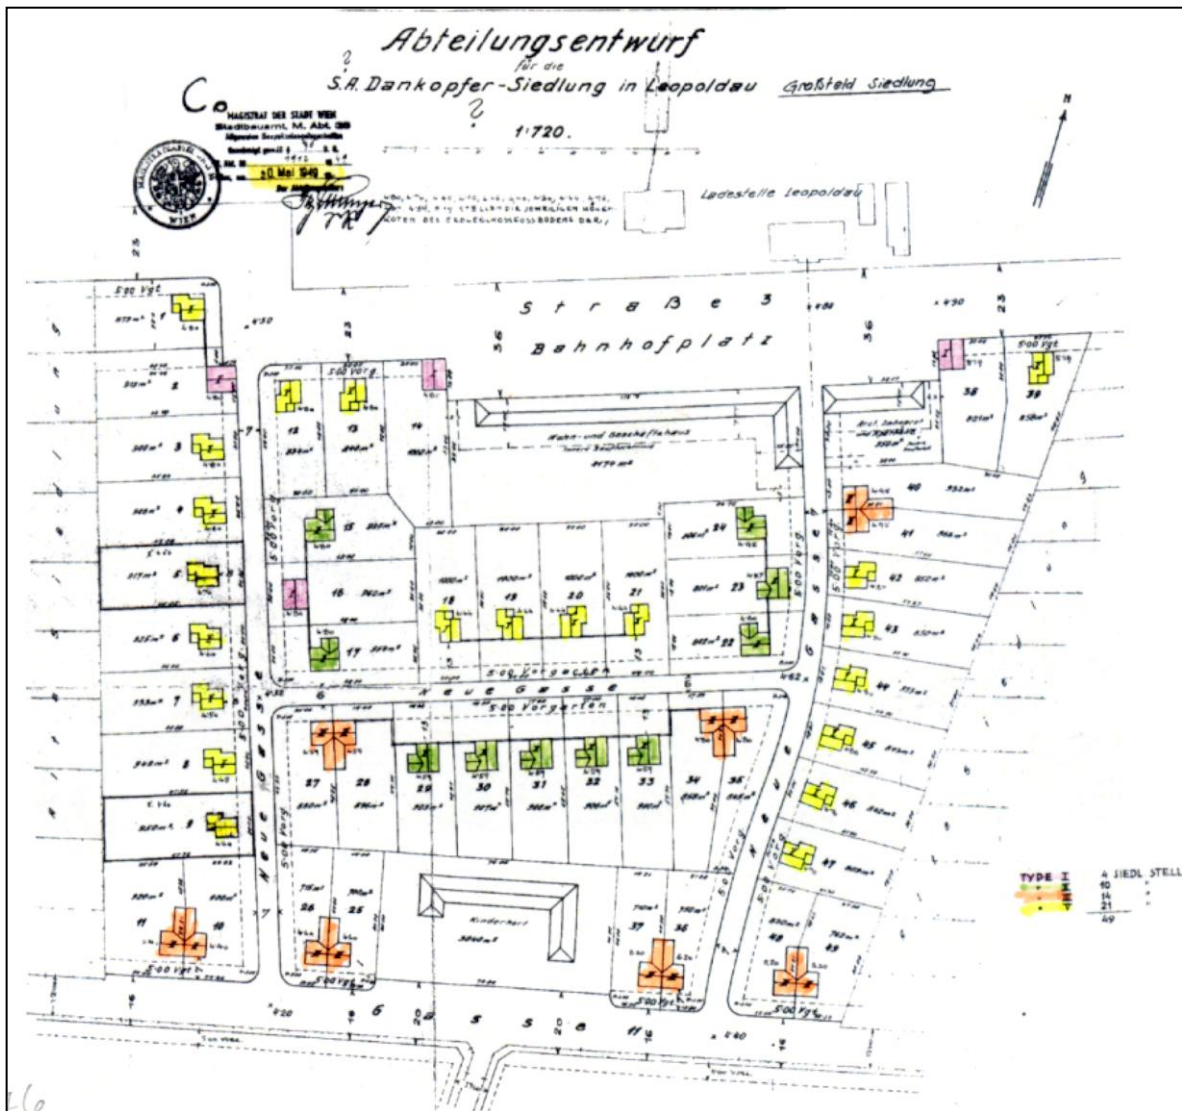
Dankopfersiedlung - Lageplan mit Haustypenangabe
